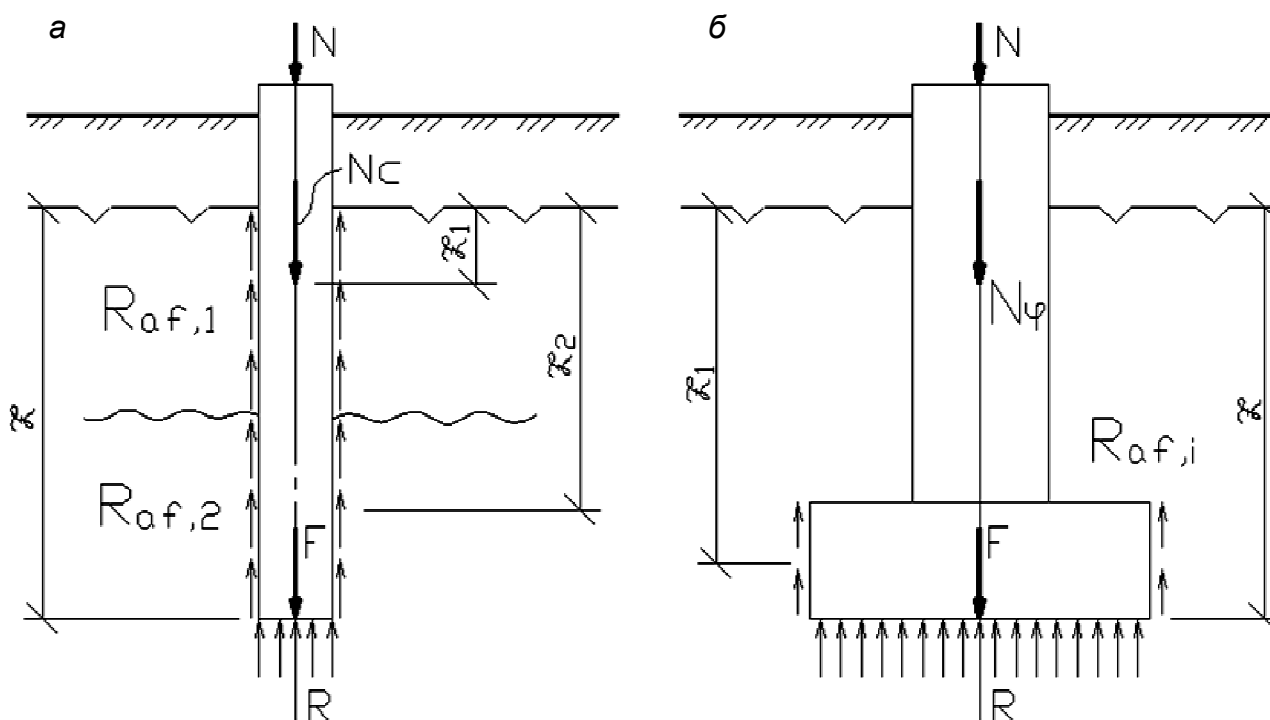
Расчетные схемы для расчёта устойчивости фундаментов на воздействие касательных сил морозного пучения: а – сваи; б – отдельного столбчатого фундамента
